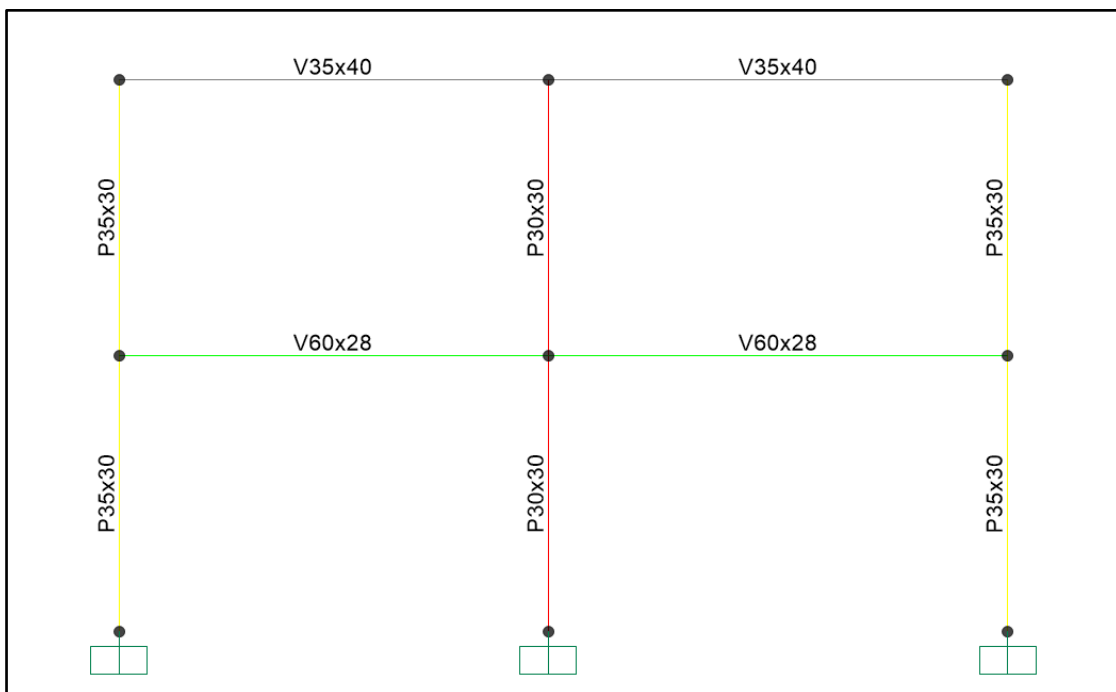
Perfiles de las jácenas y los pilares del Pórtico B.
